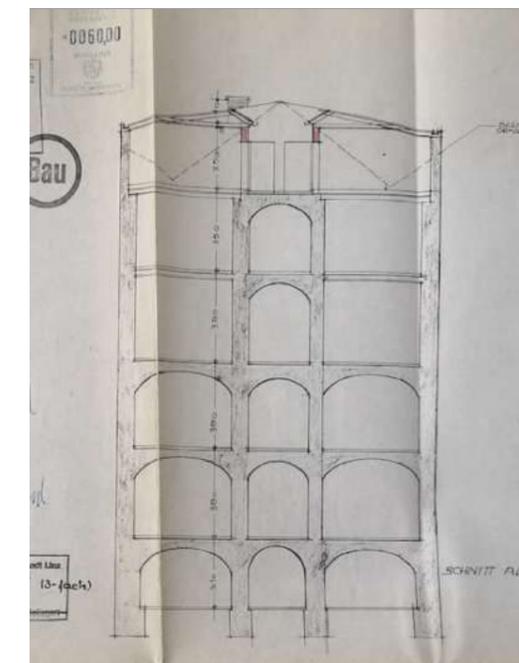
zeigt Einreichplan zum Dachausbau 1988
